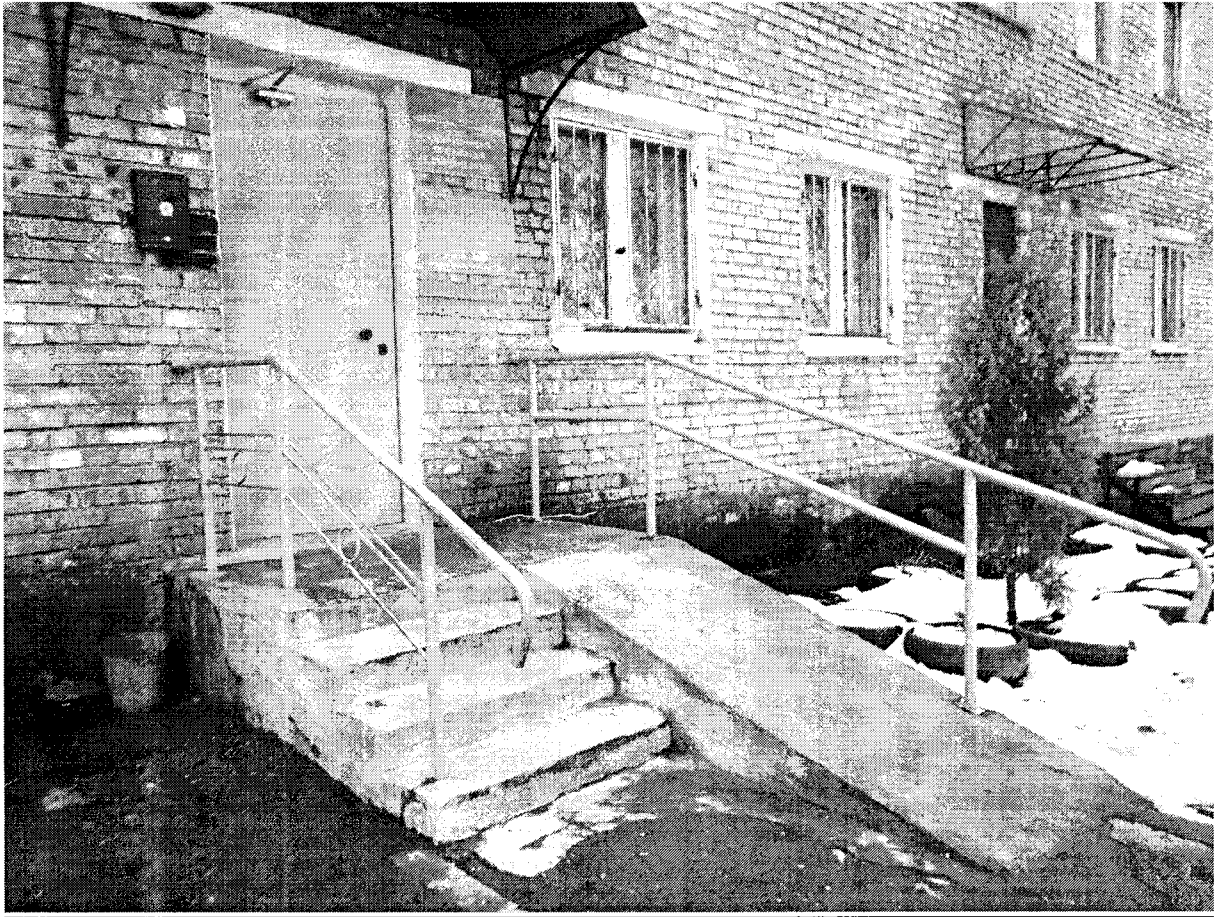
Вход в здание (лестница наружная, пандус, входная площадка и дверь)
